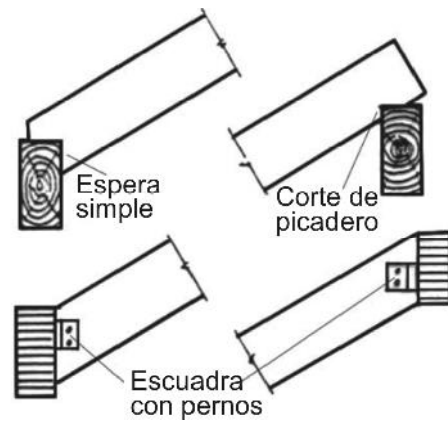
Cubierta Par y Picadero, apoyada en viga cumbreira.
